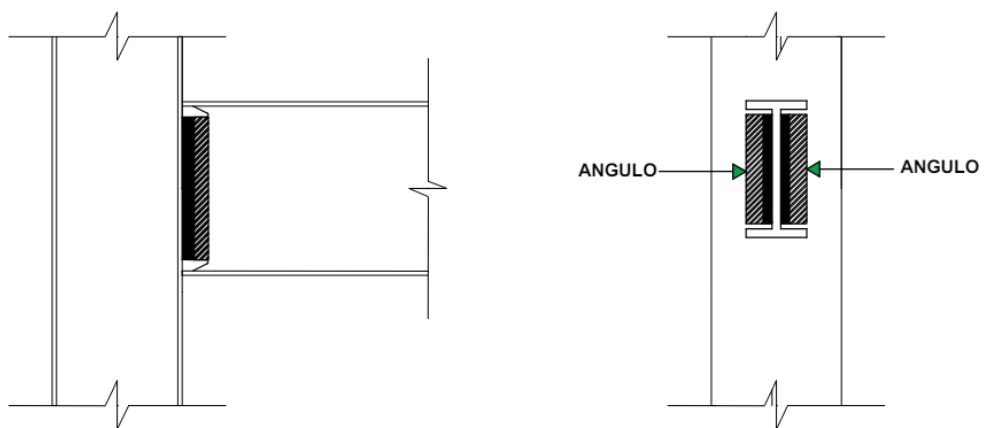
Viga I soldada patín y alma con ángulos actuando como placa de cortante.
